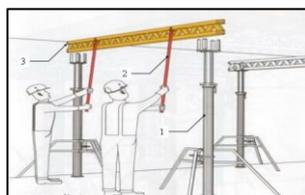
Монтаж продольных балок: 1 - основная стойка с треногой и унивилкой; 2 - монтажная штанга; 3 - монтируемая продольная балка
